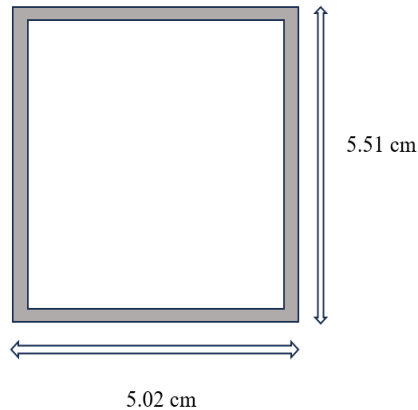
Dimension de la dalle pleine la plus défavorable.
